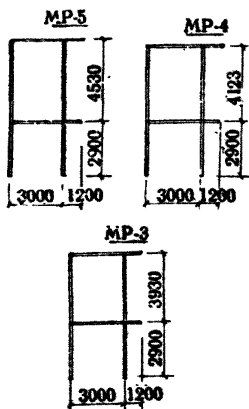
Технологическая схема монтажа III яруса металлических конструкций надстройки рабочего здания РС 4x175 двумя башенными кранами КБ-401А
